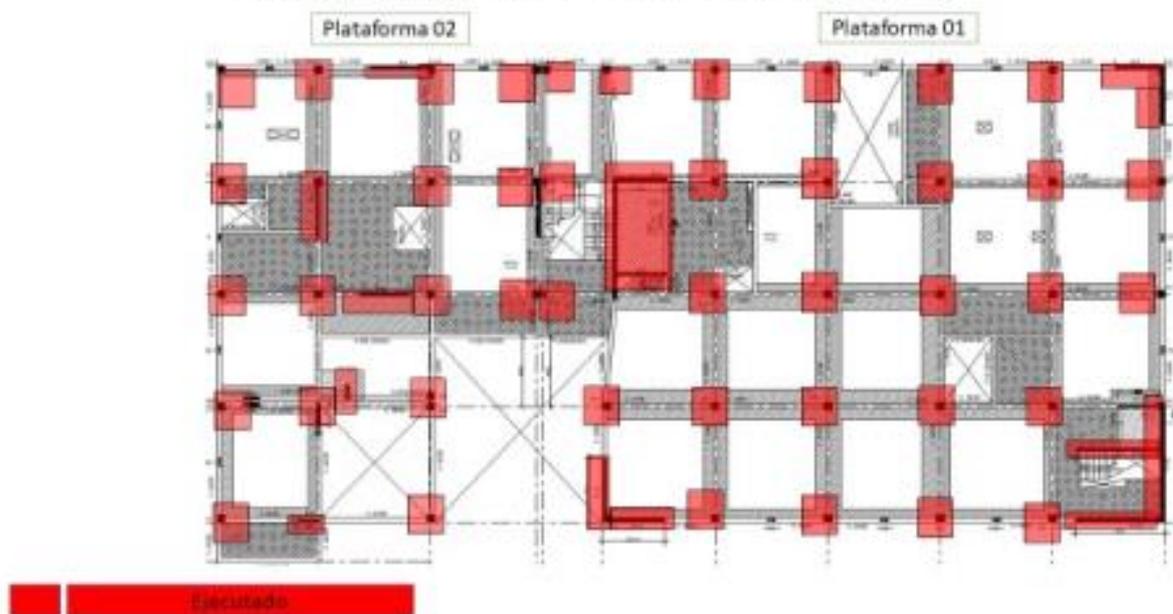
Colocación de acero en Columnas y Placas en plataforma 01 y 02.
